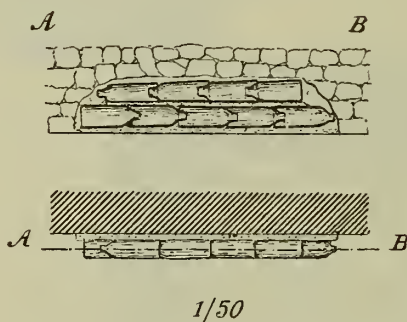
Auf- und Grundriss der Ostwand im Raume 10 der Bäder mit eingebauten Heizröhreneihen.
